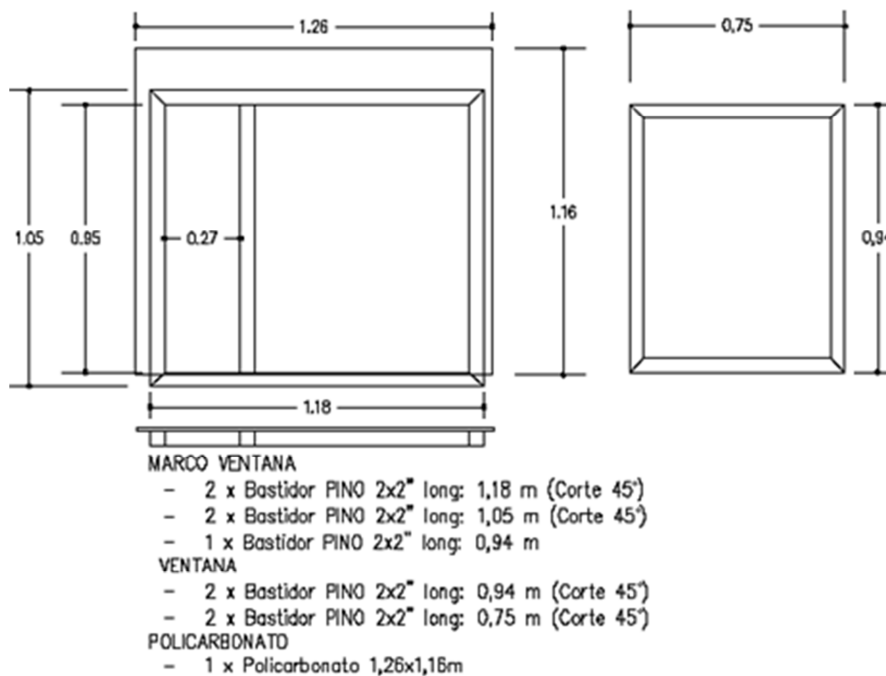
Detalle constructivo de las ventanas. Fuente: Documentación provista por TECHO.
